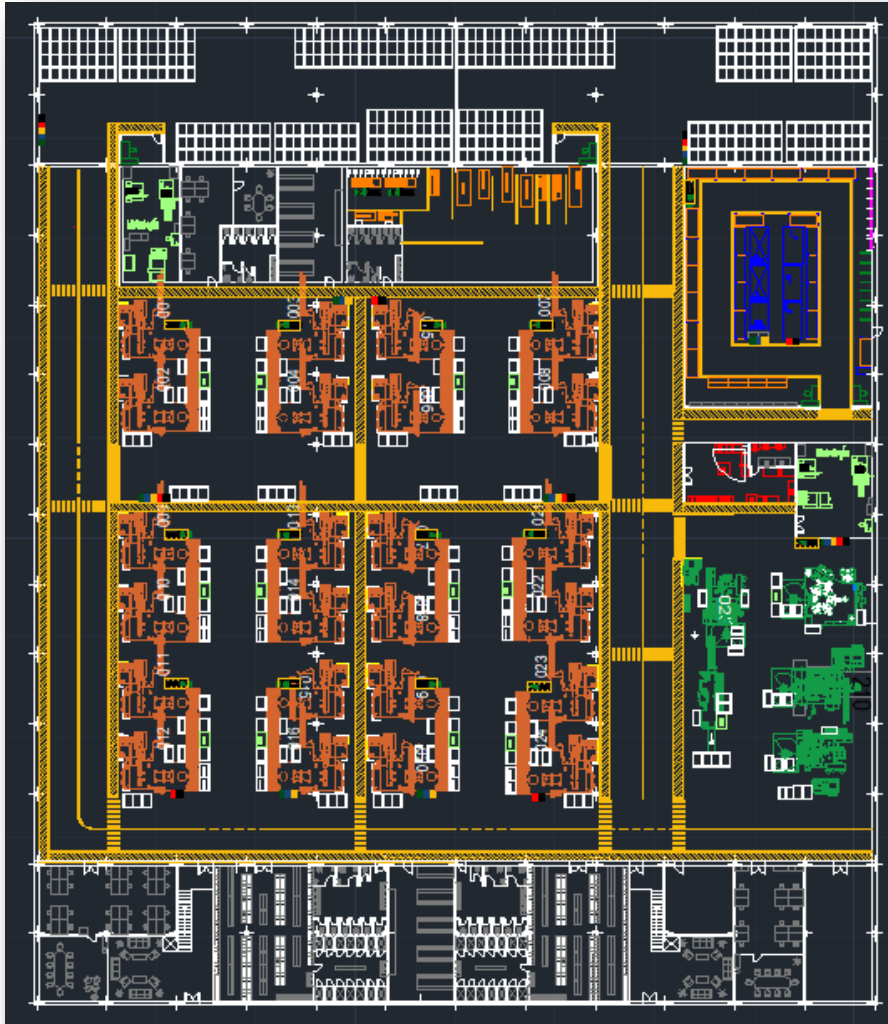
Plano de planta AutoCAD donde se muestra el comienzo de la planta con los bloques insertados Fuente: Elaboración propia
